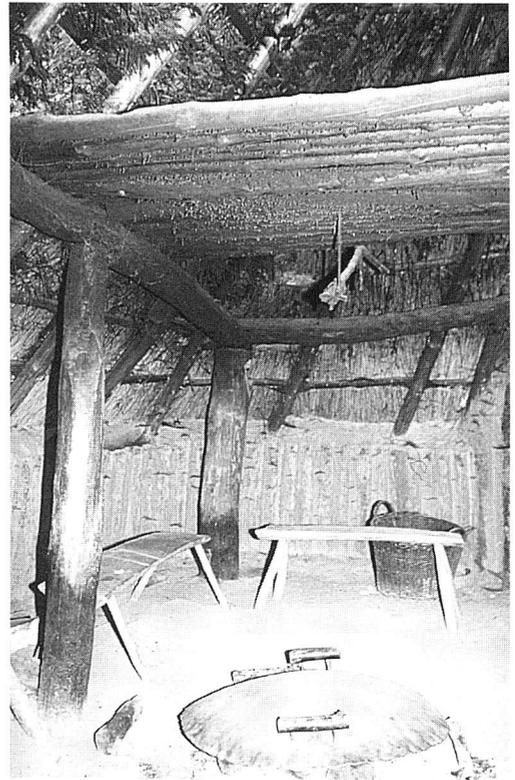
Feuerschutzdecke im nachgebauten Haus.
